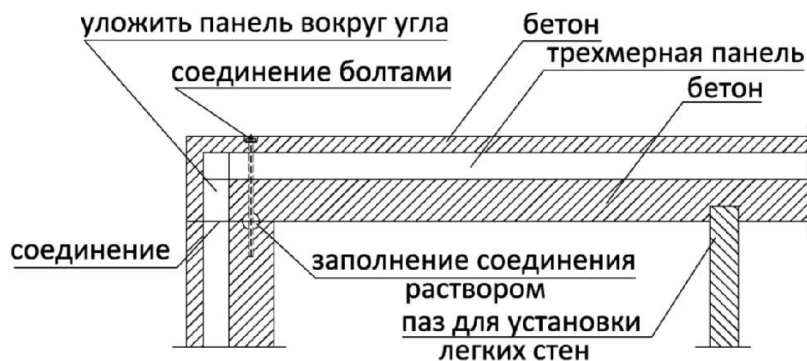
Возможности соединений для стен, изготовленных на заводе (часть плана стен первого этажа).
